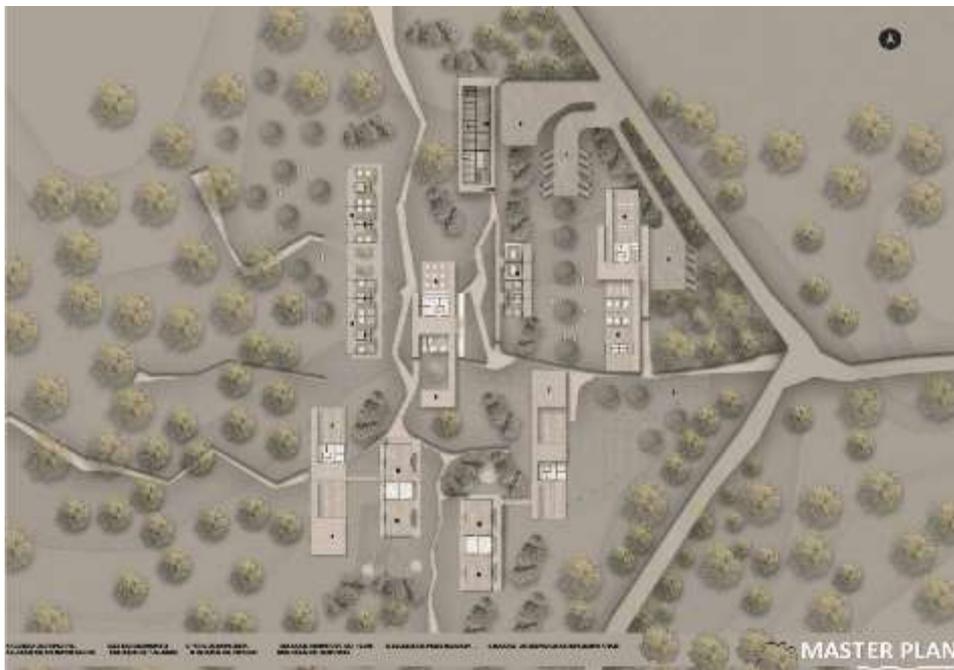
Máster Plan. Fuente: Elaboración propia
